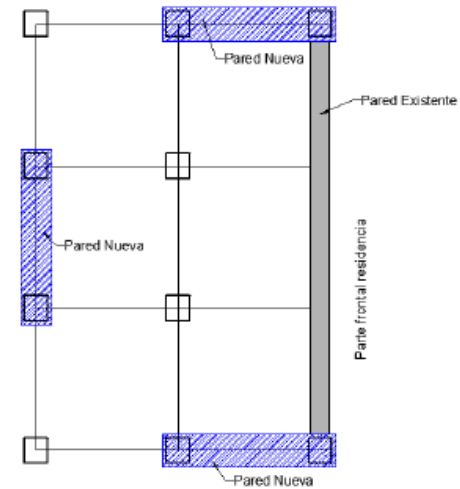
Vista en Planta de Casa en Zancos con Posible Localización de las Paredes Nuevas
